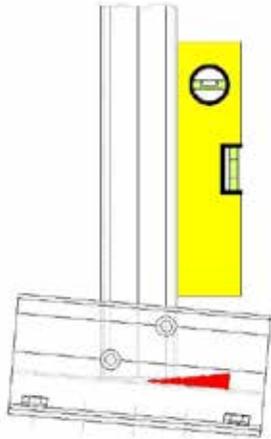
Ausrichten und Verschrauben des LB Stützenprofils.
